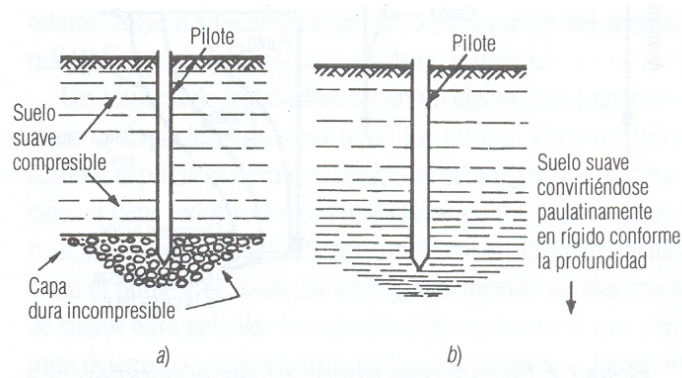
a) Pilotes de Punta b) Pilotes de Fricción
